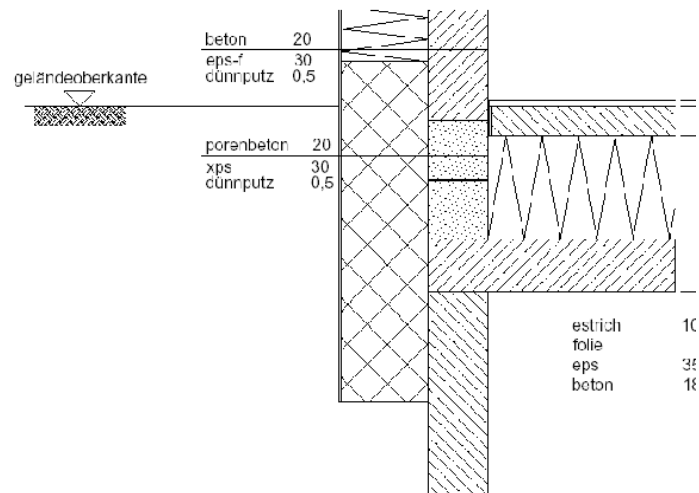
Unterste Geschossdecke - Schnitt durch Auflager aus Porenbeton [Schöberl&Pöll OEG]
